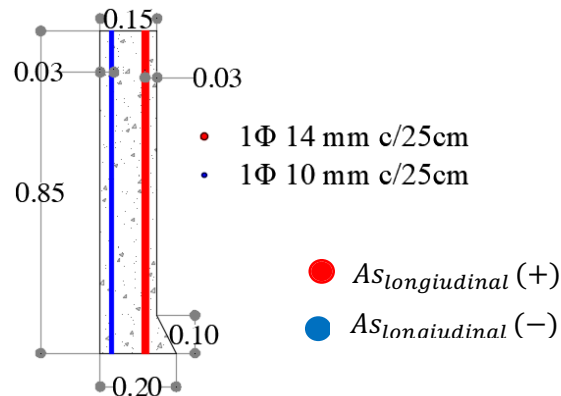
Armado de la protección de hormigón armado (maciza), sentido transversal
